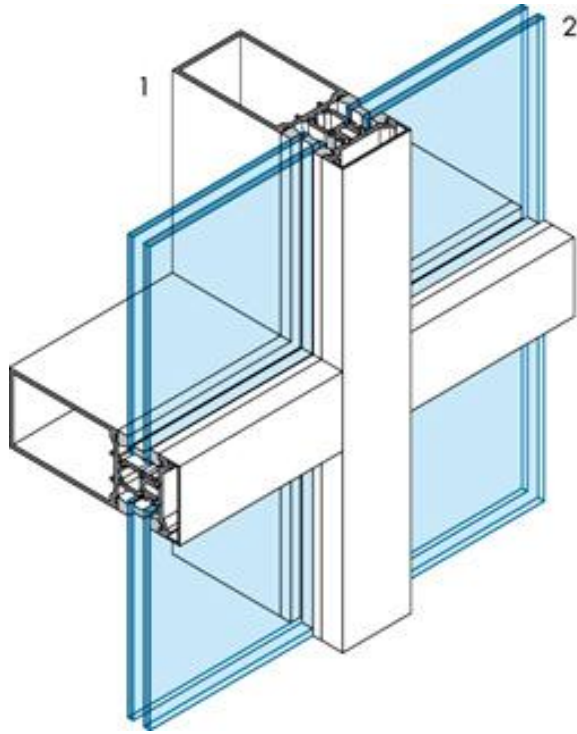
Fachada doble piel en vidrio con estructura metálica
